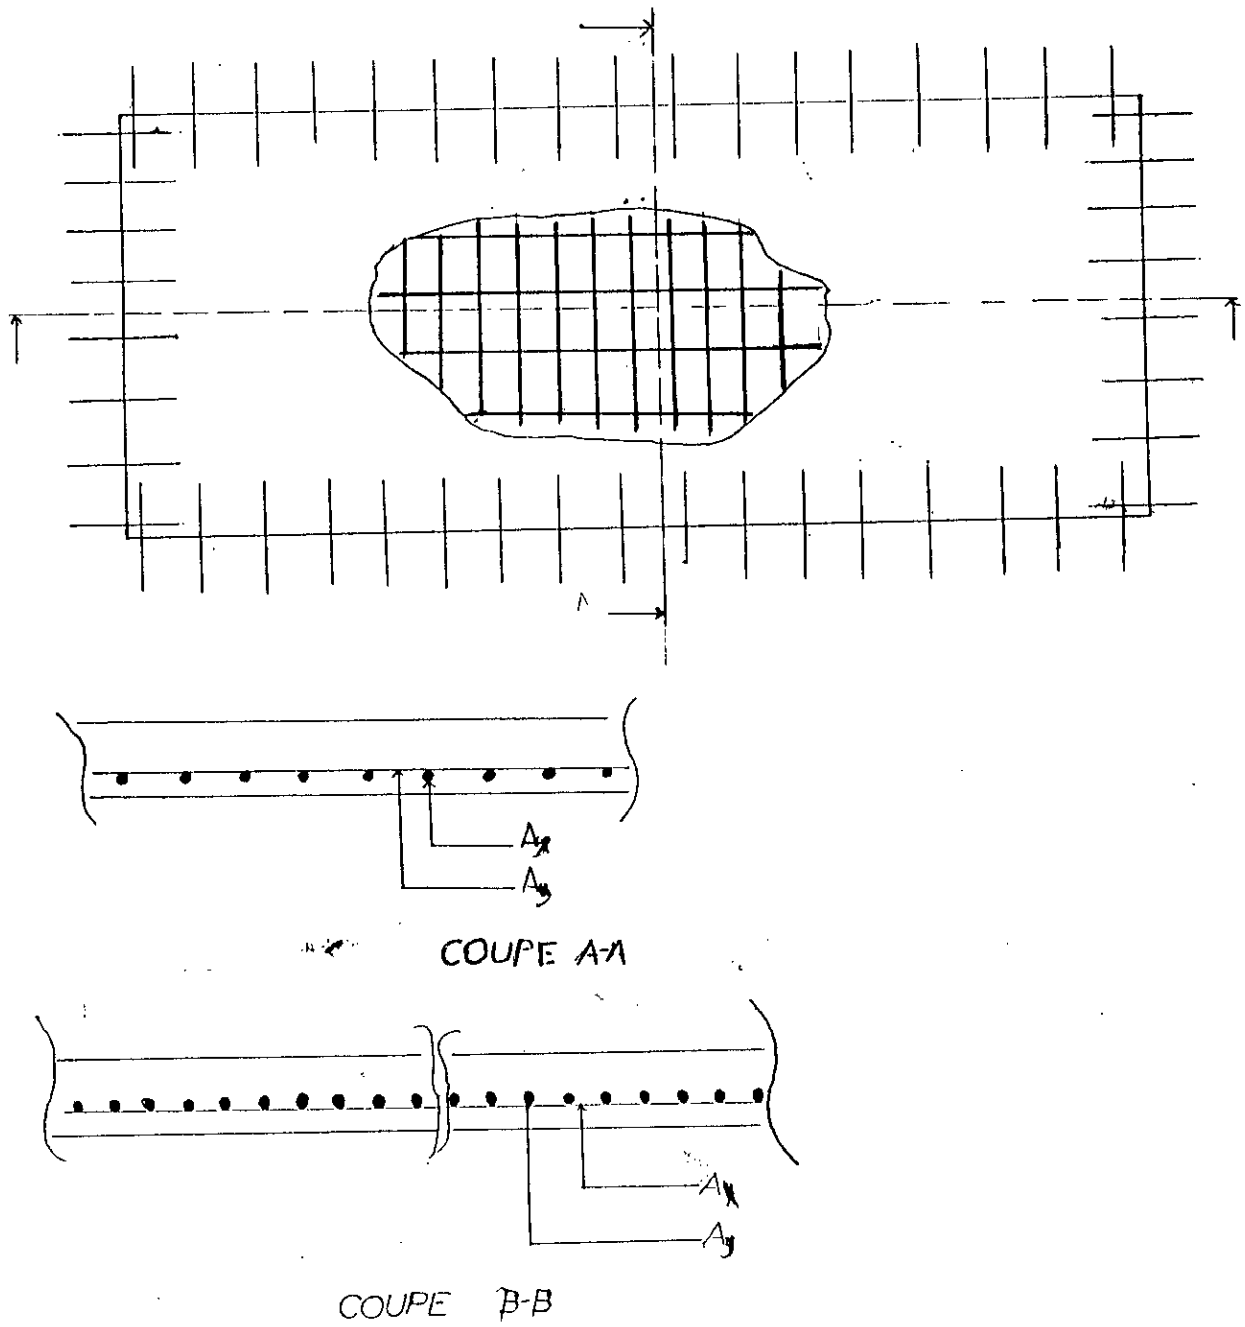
FERRAILLAGE D'UNE DALLÉ CONTINUE D'UN ETAGE COURANT
